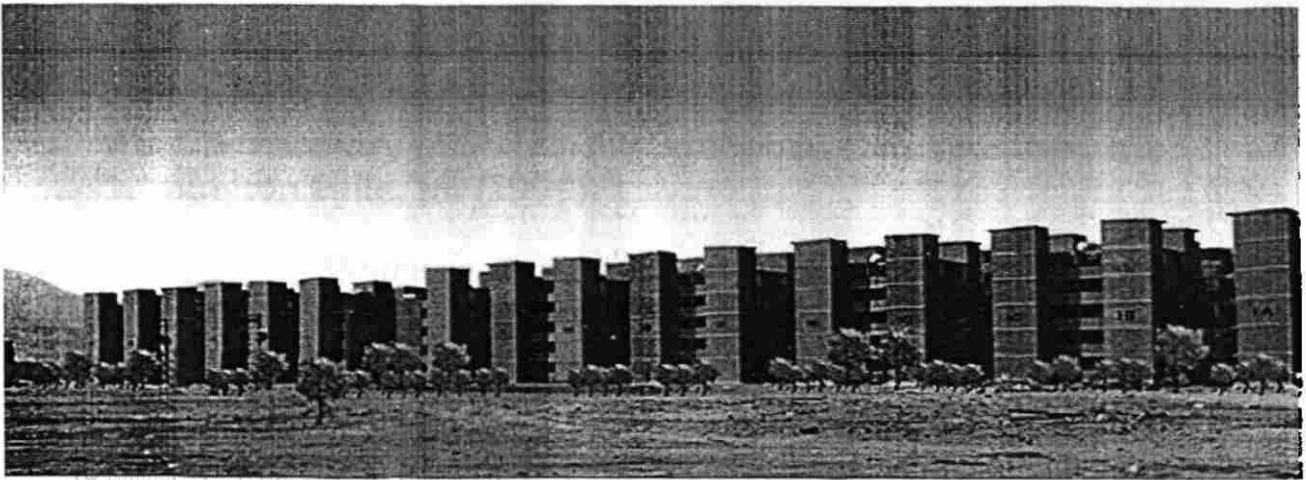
Construcciones comunes con mampostería reforzada.
